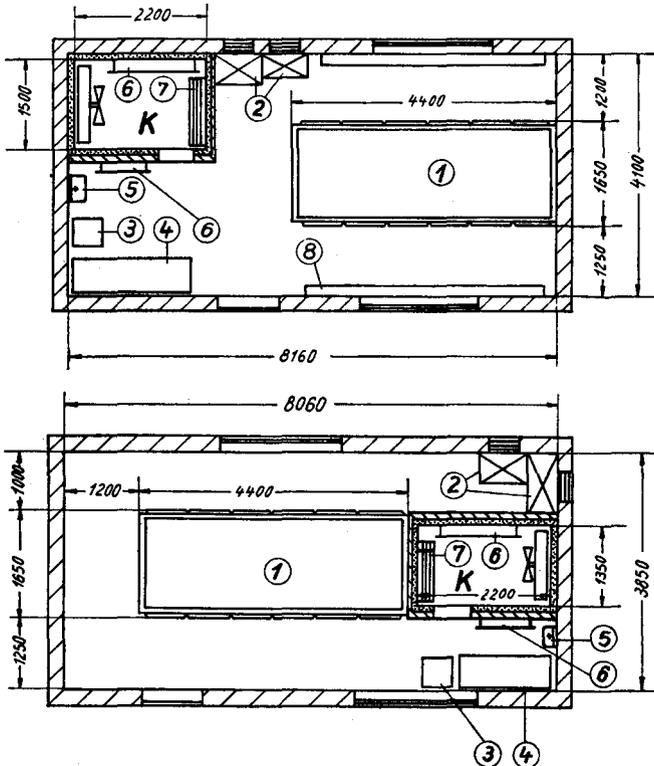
Grundrisse von Schrankanlagen mit Kühlraum und Verarbeitungseinrichtungen (1) 36 Fach-Schrankanlage mit stiller Kühlung durch Verdampferplatte, (2) Kältemaschine für den Gefrierschrank und den Kühlraum, (3) Hackklotz, (4) Arbeitstisch, (5) Spülbecken, (6) Fleischgehänge, (8) Abstellbretter, (K) Kühlraum, (7) Regal.
